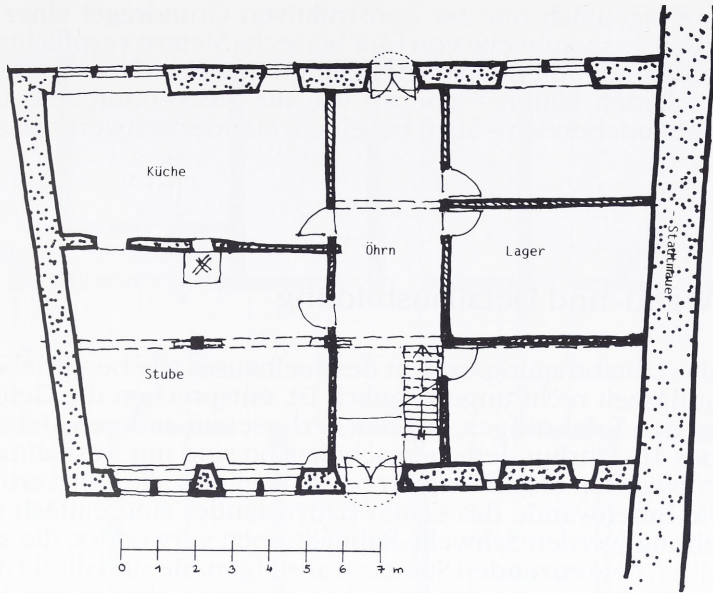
Öhringen, Seelhaus. Rekonstruktionsskizze des ersten Bauzustandes (1553 ff.), Erdgeschoßgrundriß, M 1:200.
